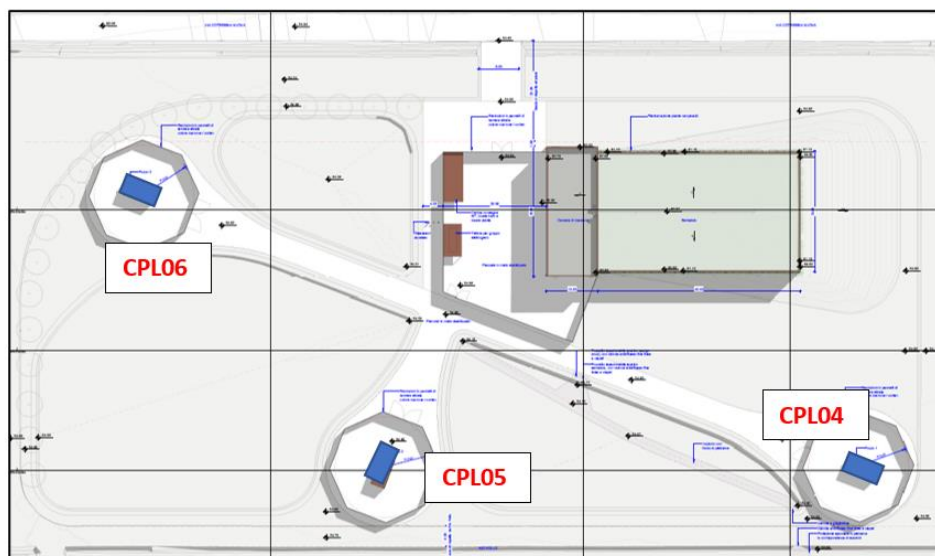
Planimetria centrale con in blu i pozzi in progetto.
